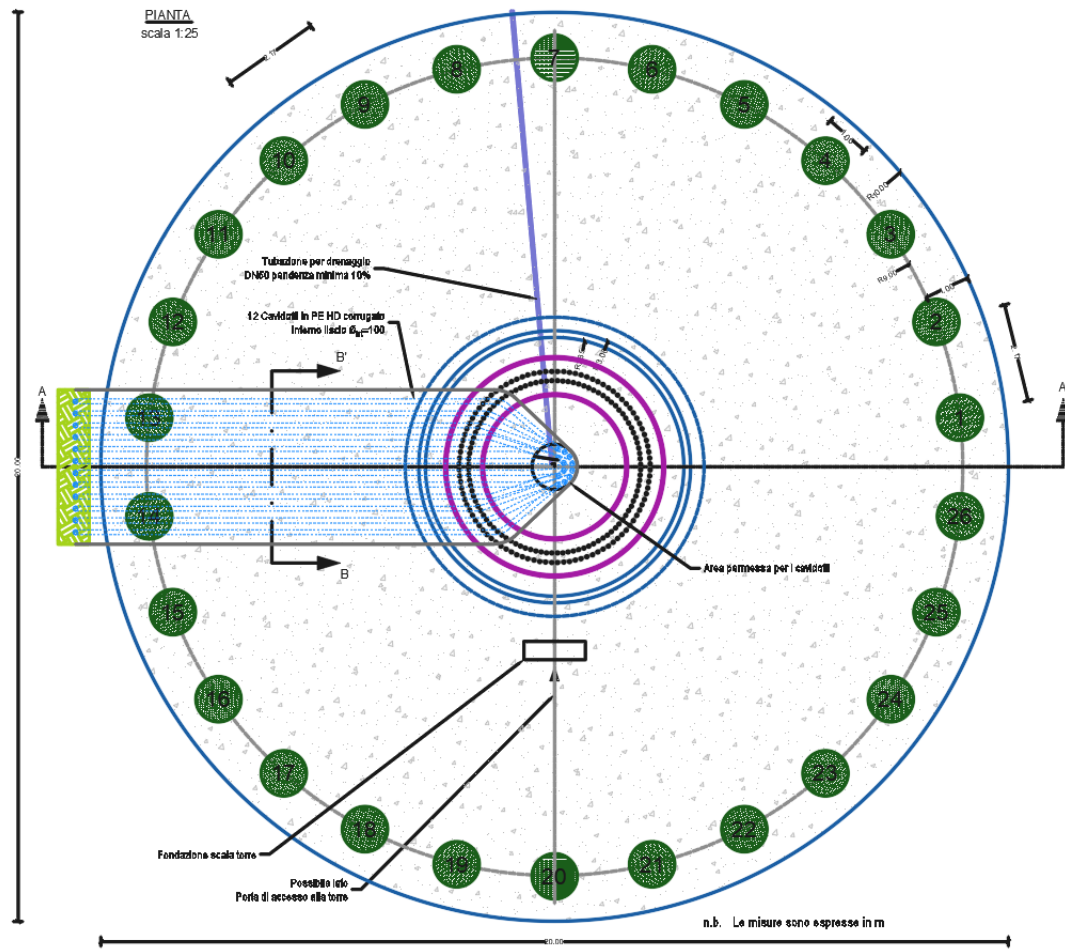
Pianta del plinto con indicazione dei pali di fondazione (n.26 del diametro 100 cm)
